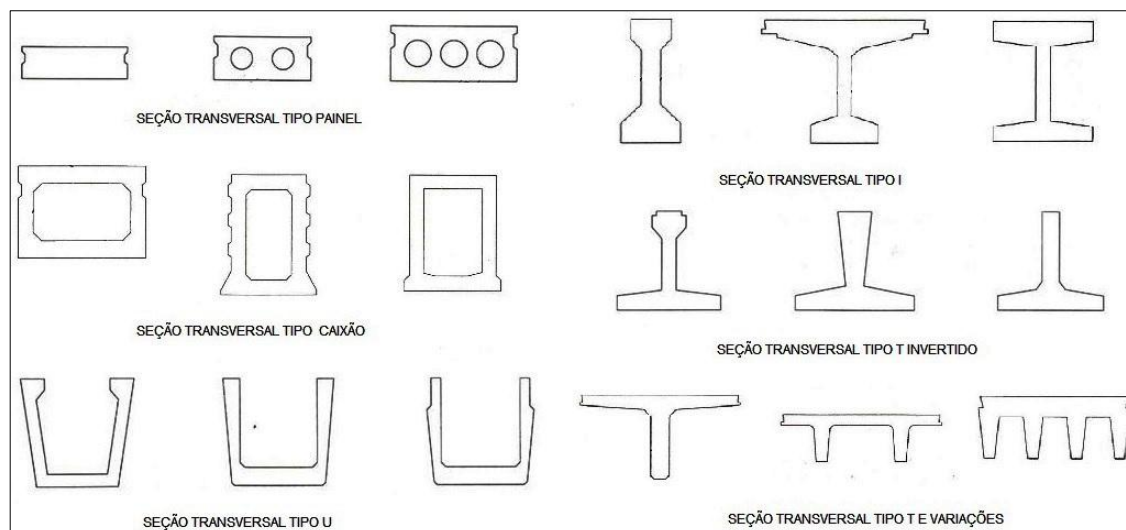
Seções de elementos pré-fabricados para a superestrutura de pontes
